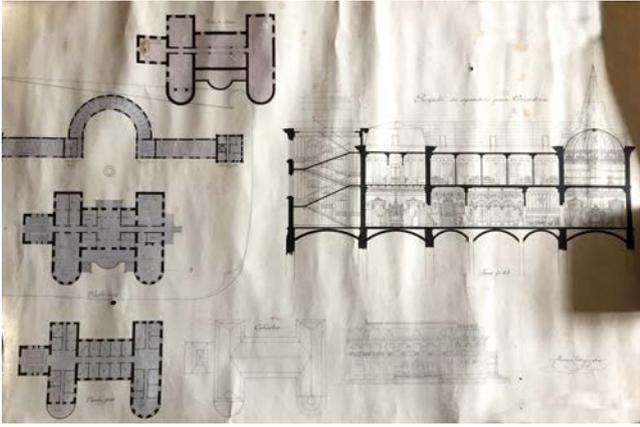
Mariano Estanga: Proyecto de Apeadero para cazadores. Alzado, plantas y sección. c. 1897.
